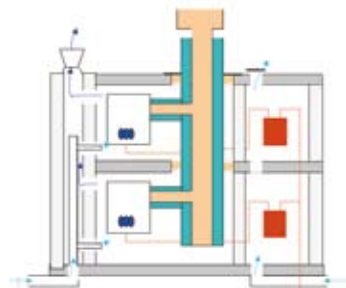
Tubage d'un conduit pour l'amenée d'air de ventilation
